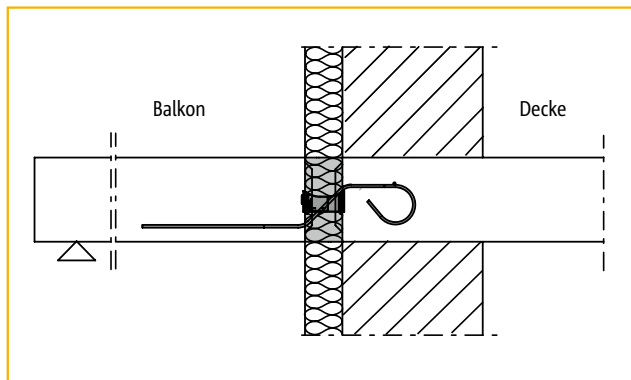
Mauerwerk mit Außendämmung bei deckengleichem Balkon
